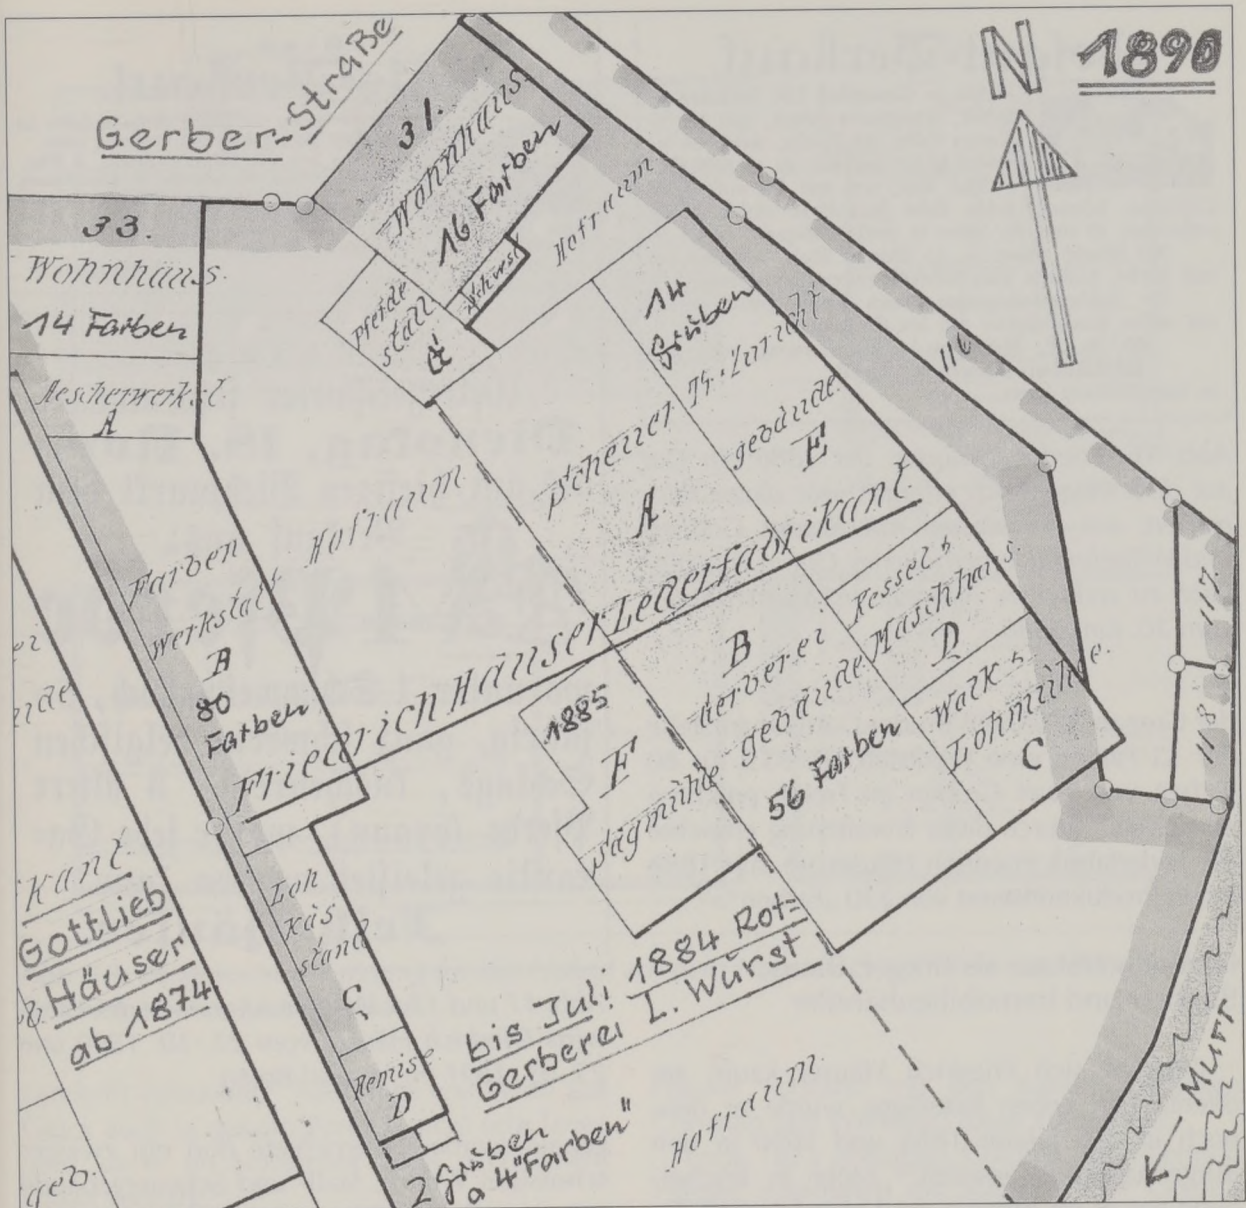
Lageplan mit der Weiterentwicklung der Lederfabrik Friedrich Häuser nach dem Brand von 1881 und dem Erwerb des Nachbargrundstücks (Gerberstraße 33).
